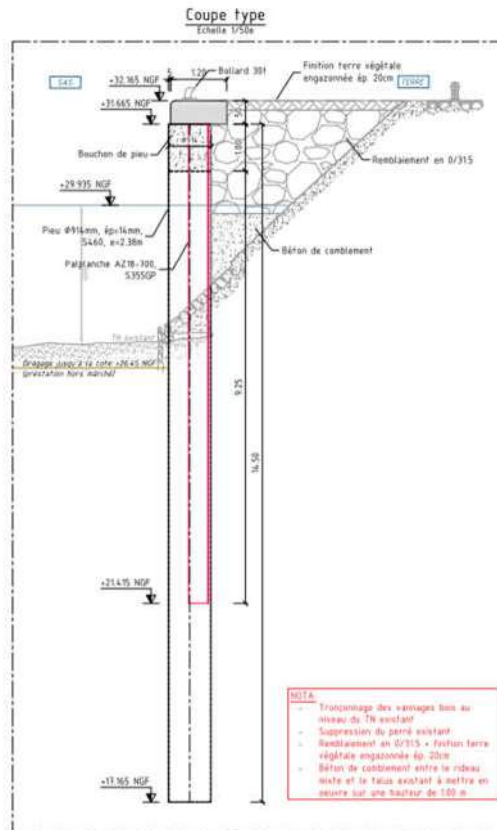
Rideau mixte, coupe type (DOE, travaux 2021-2022)
